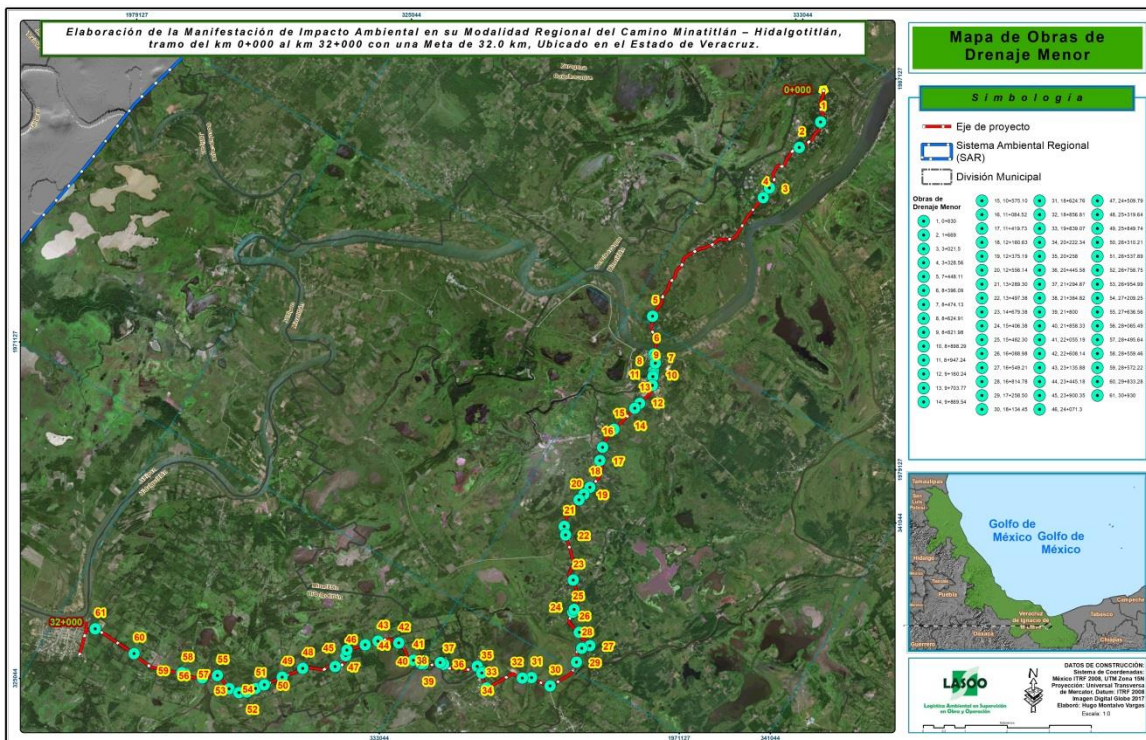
Ubicación de las obras de drenaje menor del proyecto
